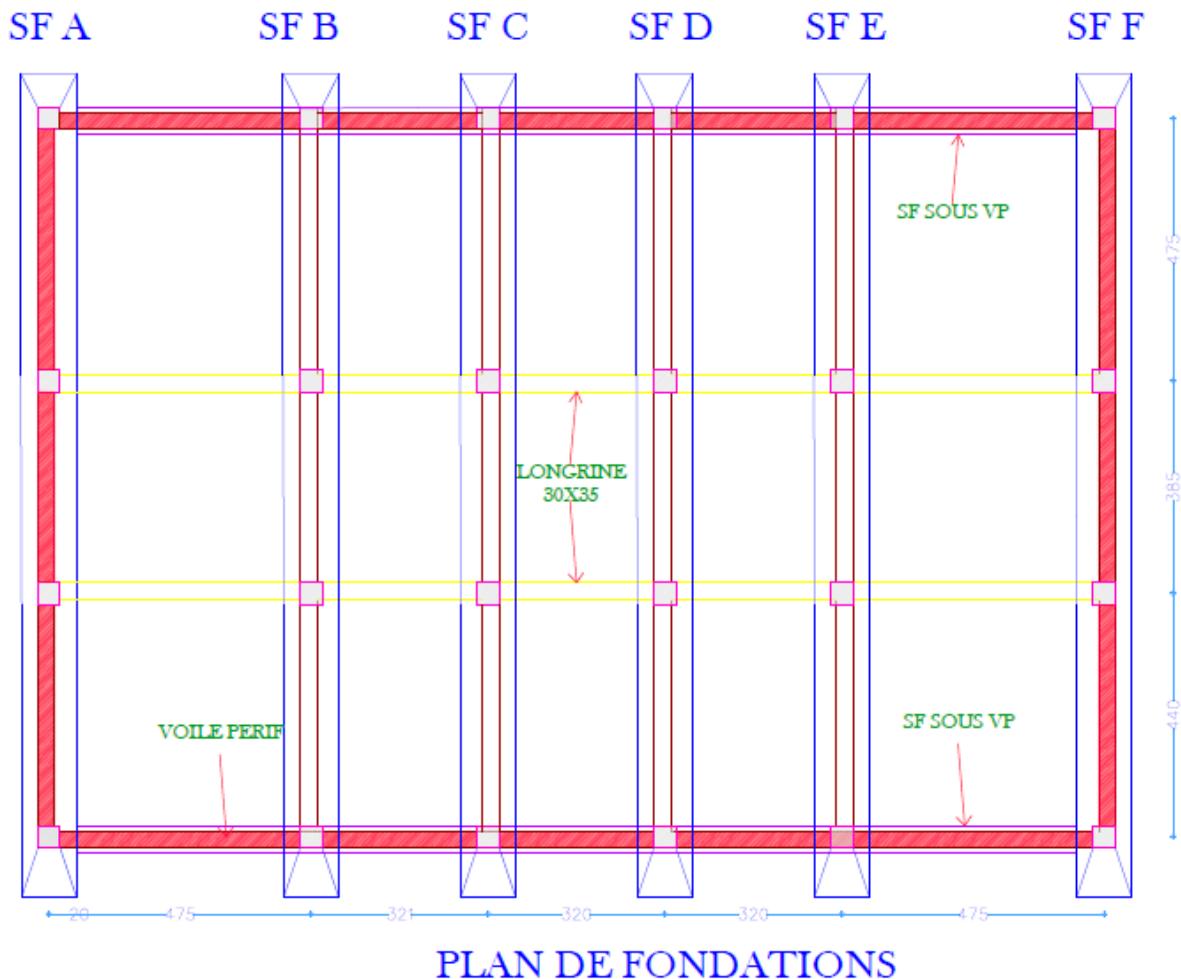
Vue en plan de la disposition des semelles filantes.
